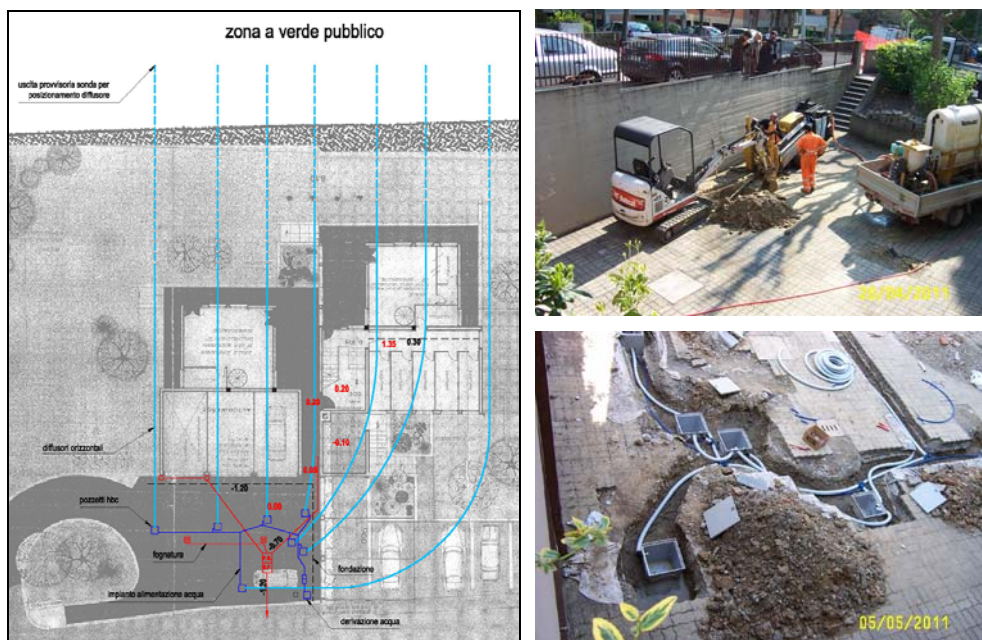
Planimetria dell'impianto as build e alcune foto relative alle fasi realizzative.
